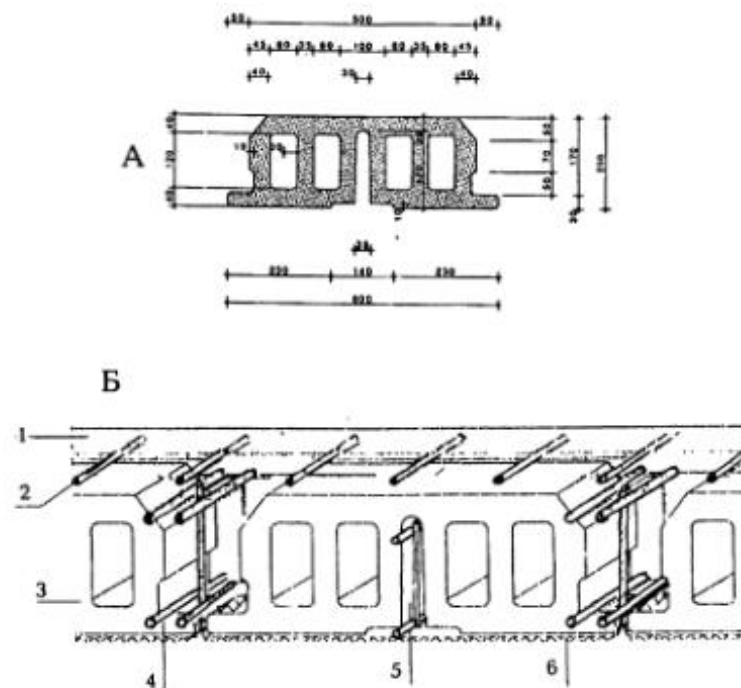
Сборно-монолитное перекрытие системы "Пластбау": А - пенополистирольный вкладыш перекрытия; Б - сечение перекрытия; 1 - бетон; 2 - арматурная сетка; 3 - вкладыш; 4 - арматурный каркас ребра плиты перекрытия; 5 - самонесущее ребро заводского изготовления; 6 - штукатурка по сетке Рабитц
